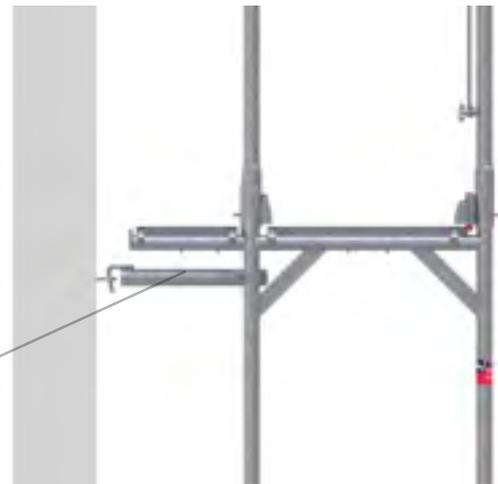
Gerüsthalter in Verwendung mit Innenkonsolen
